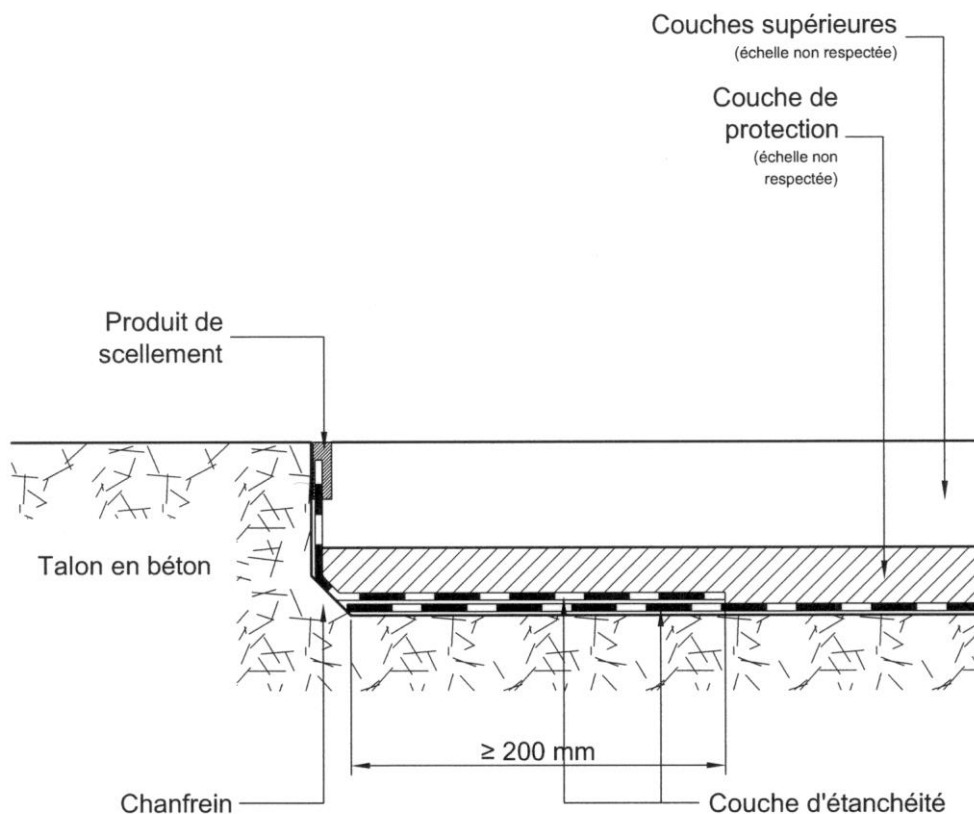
c. Traitement d'une discontinuité de niveau sans ancrage de l'étanchéité
